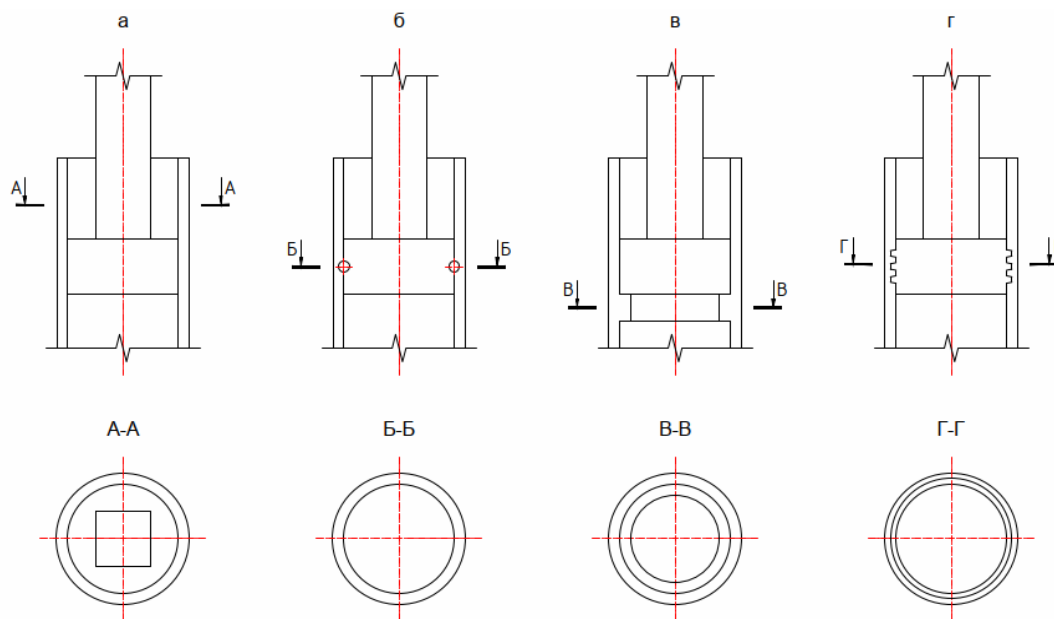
Конструктивные типы узлов сопряжений стоек порталных опор со сваями-оболочками: а – распорный (У1); б – с выпусками спиральной арматуры (У2); в – с бетонной диафрагмой (У3); г – со шпоночным соединением пробки со свай (У4)
